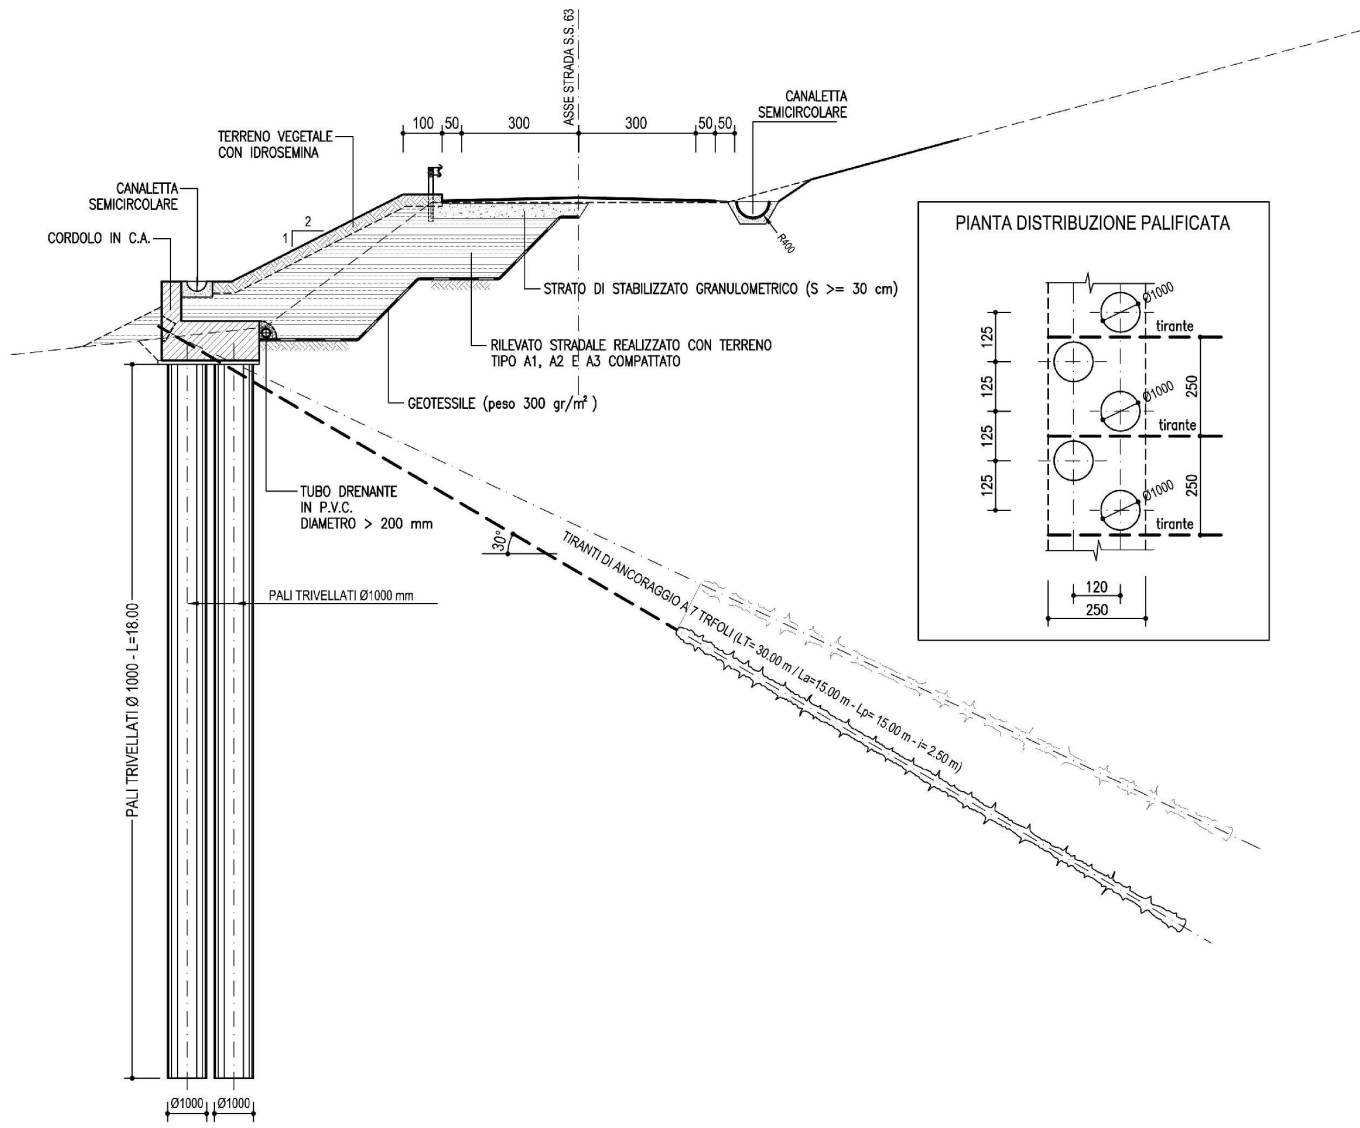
Sezione tipo dell'intervento A, muro su pali tirantato
